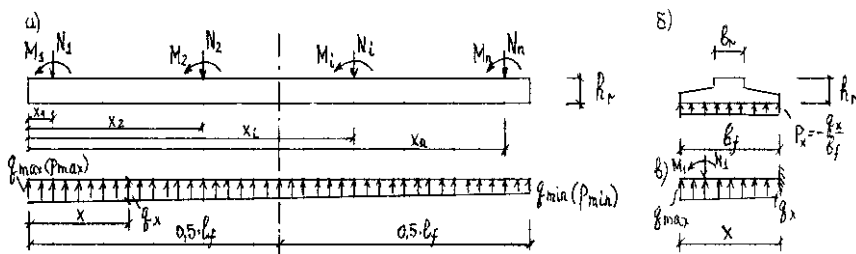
Расчётные схемы ленточного фундамента под ряды колонн по методу прямолинейной эпюры: а – вдоль оси ленты, б – в поперечном направлении, в – при определении внутренних усилий
